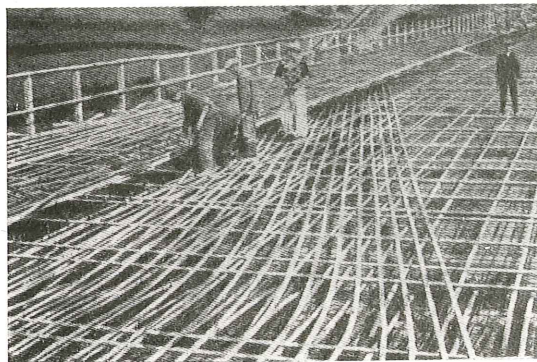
Detalle de las armaduras de pretensado, longitudinales y transversales, del tablero de la figura anterior. El esfuerzo máximo de pretensado longitudinal en apoyos es de 6.000 t. El transversal varía entre 26 t/m l hasta 170 t/m l, en los apoyos extremos, como consecuencia de que el tablero forma el alma de la viga contraviento.
